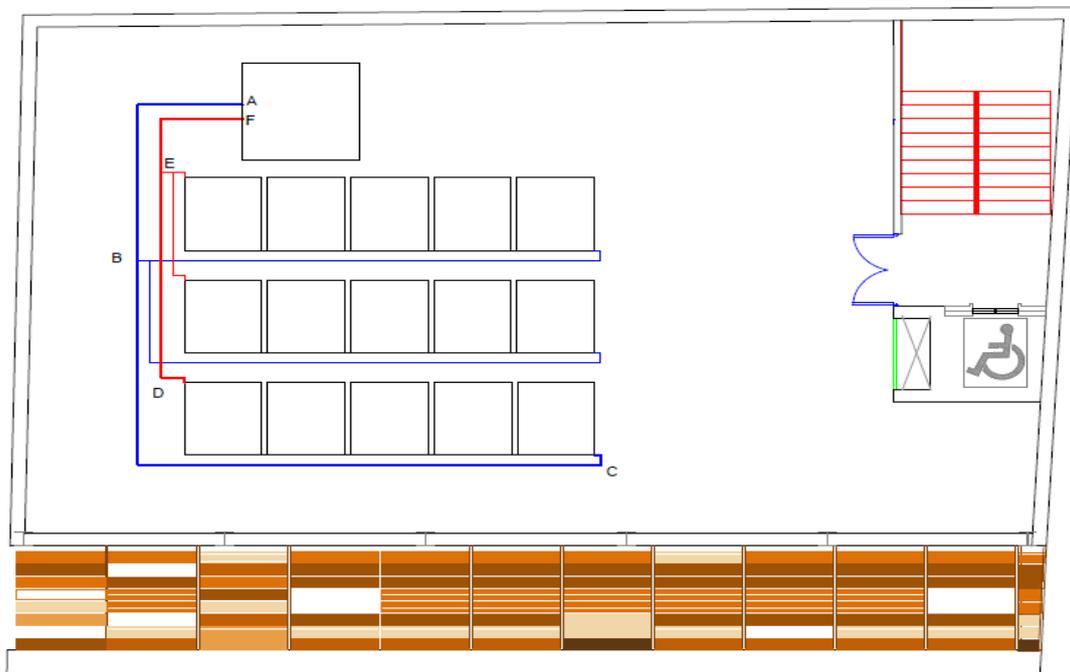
Distribución en planta de la instalación solar en cubierta del edificio.
